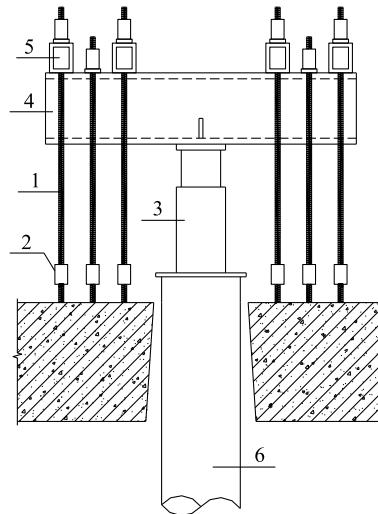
新增托换桩的桩顶持荷系统示意图
